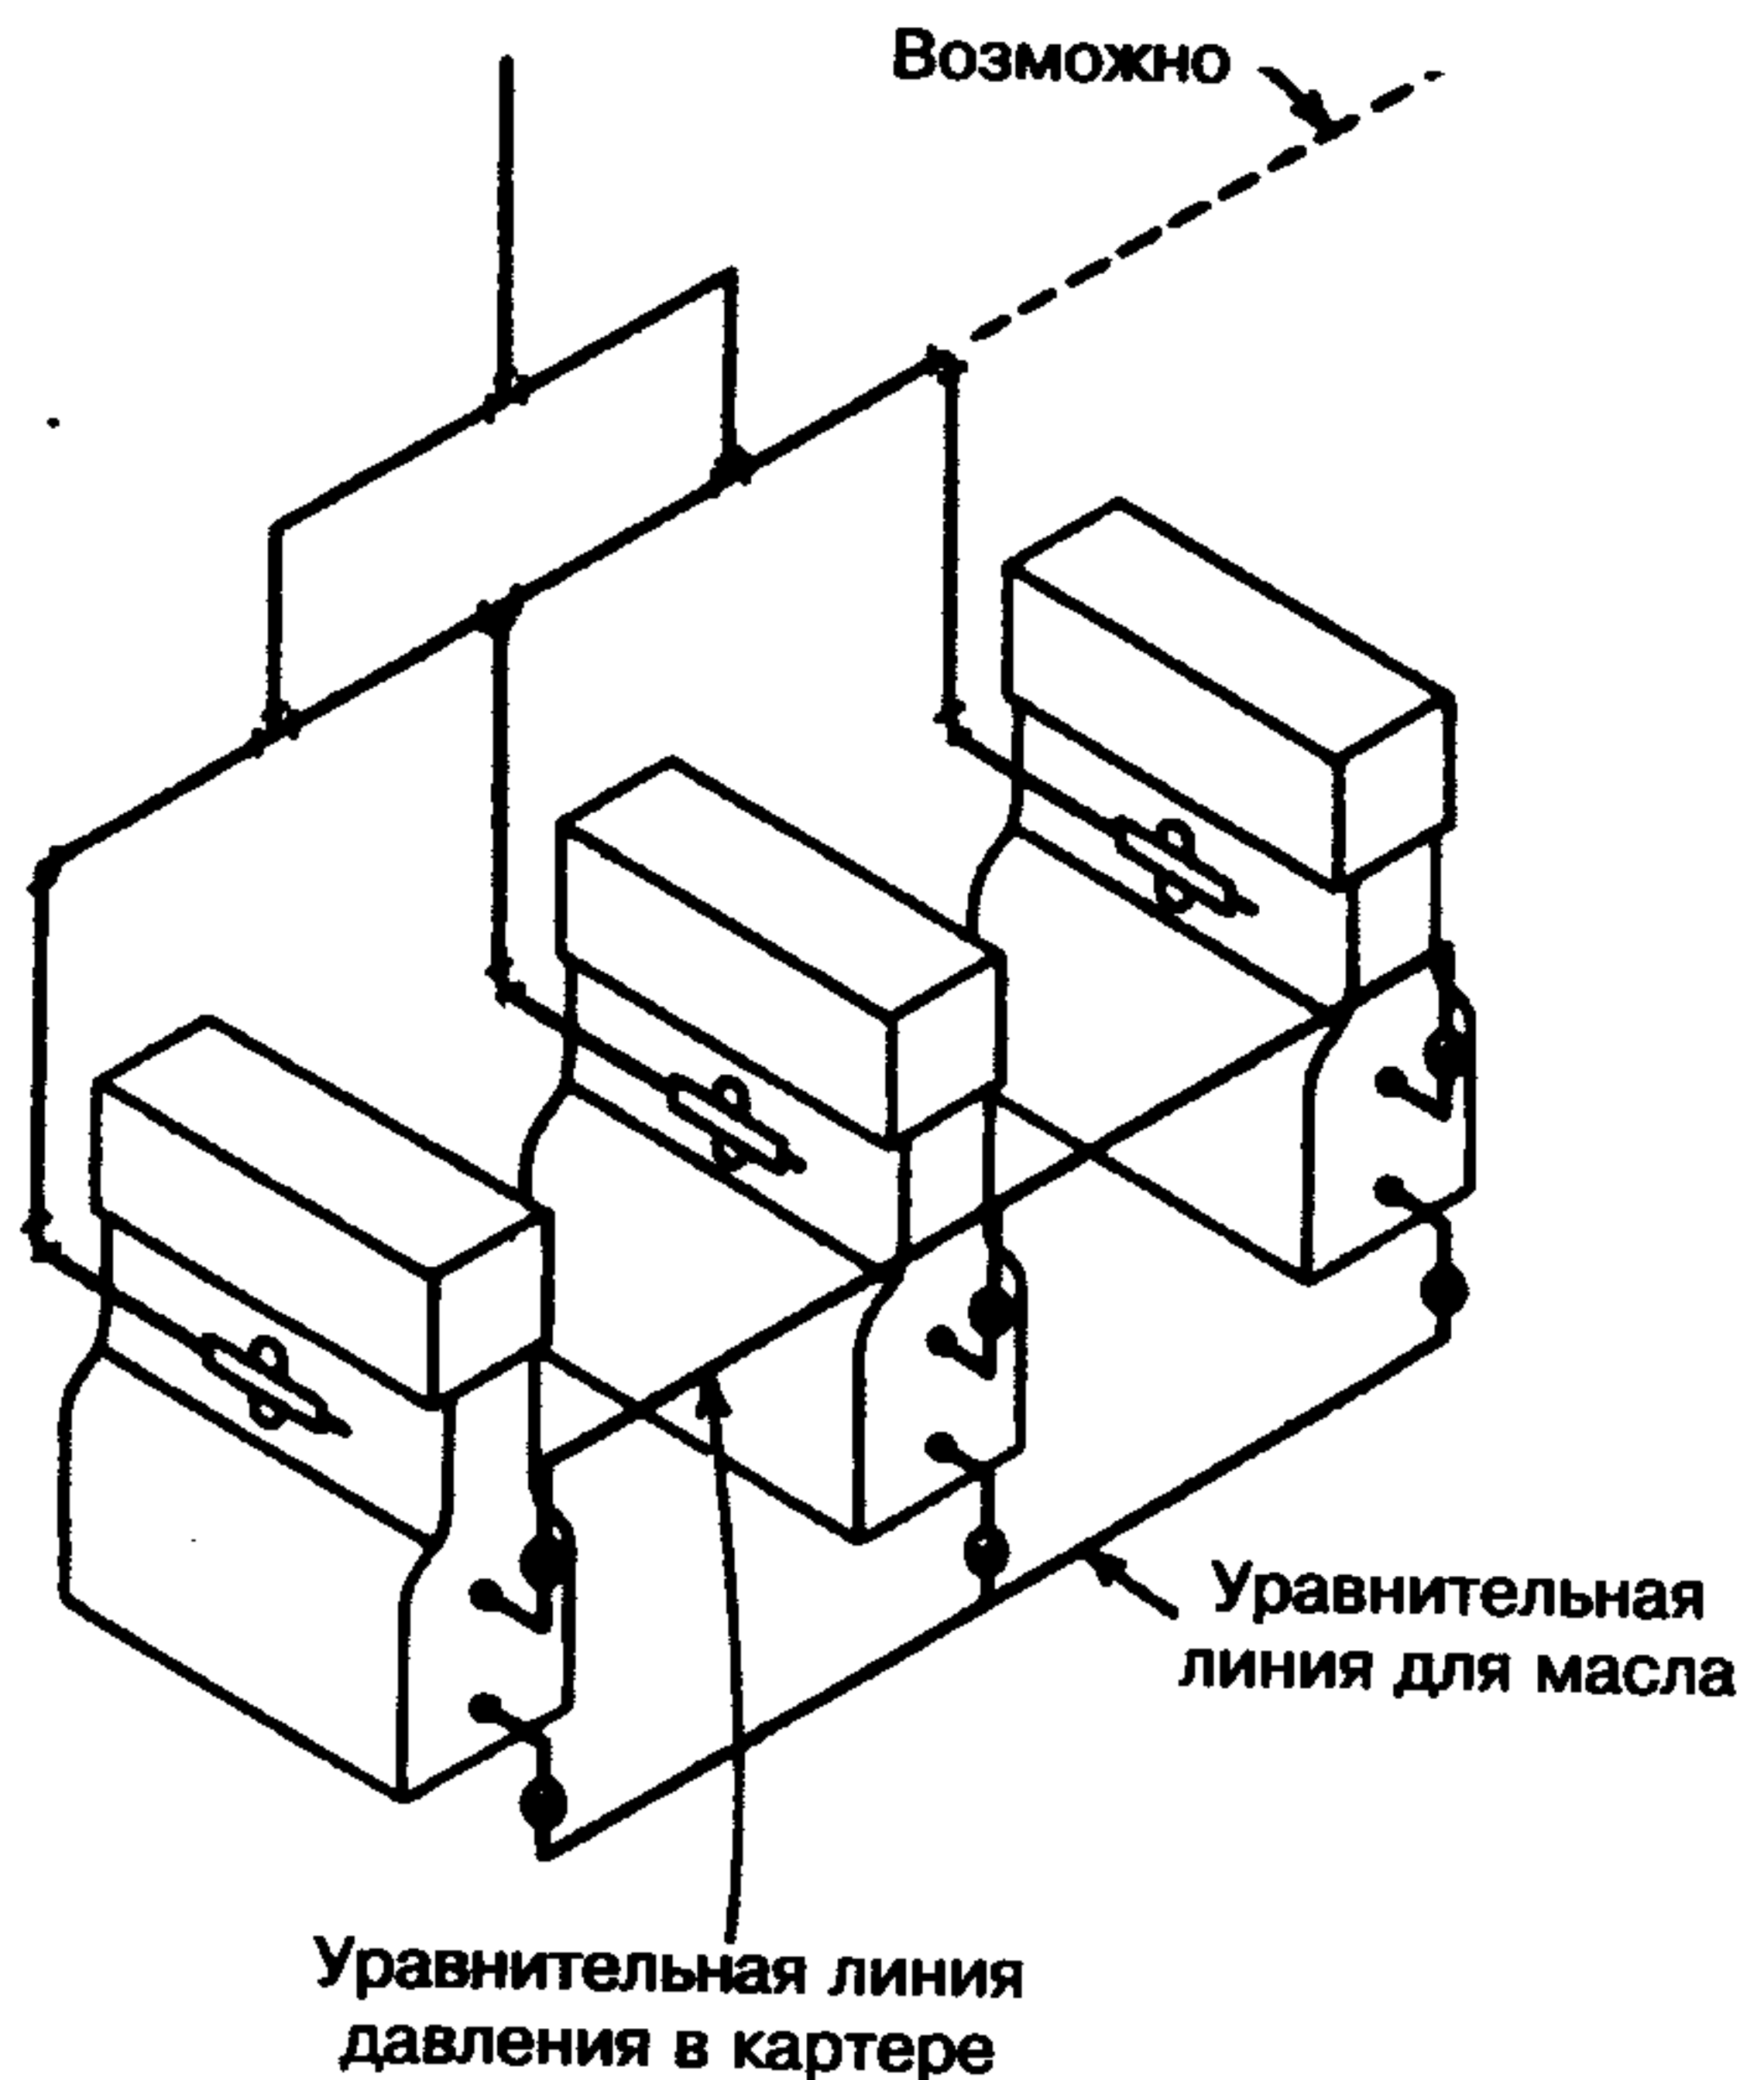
Параллельный всасывающий трубопровод компрессоров
